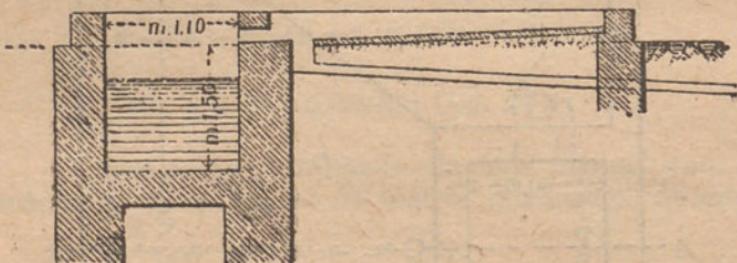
Estrumeira de um pavimento e fossa inclusa—Corte por A B
